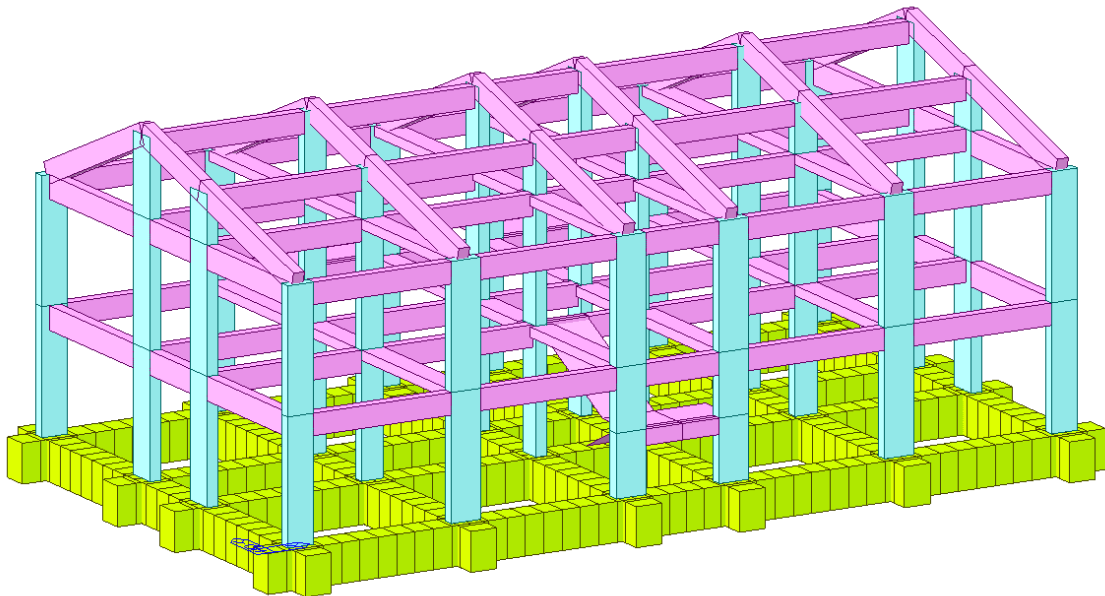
Modello FEM edificio a due piani in c.a. con trave rovescia - Vista assometrica 1.
